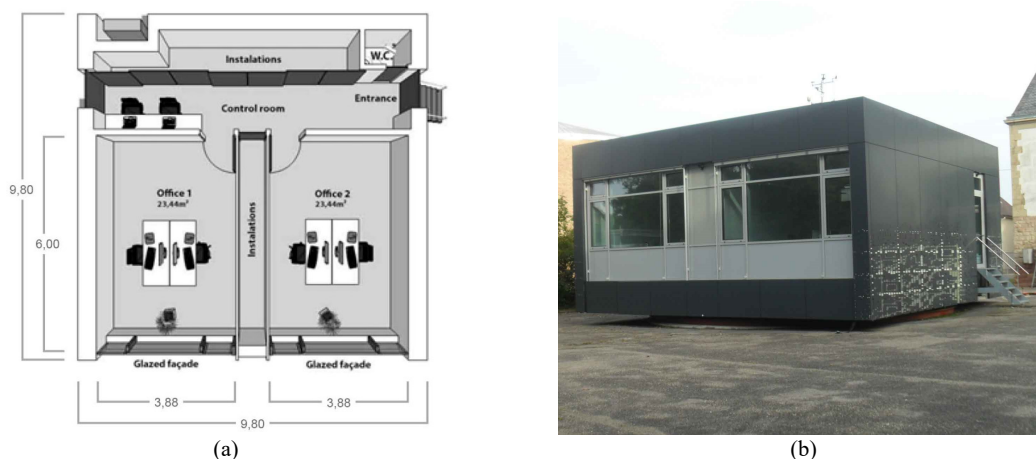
(a) Planta baixa perspectivada do LOBSTER. (b) Vista externa geral da câmara climática e das aberturas envidraçadas. Fonte: TAMURA; KRÜGER, 2016b.
